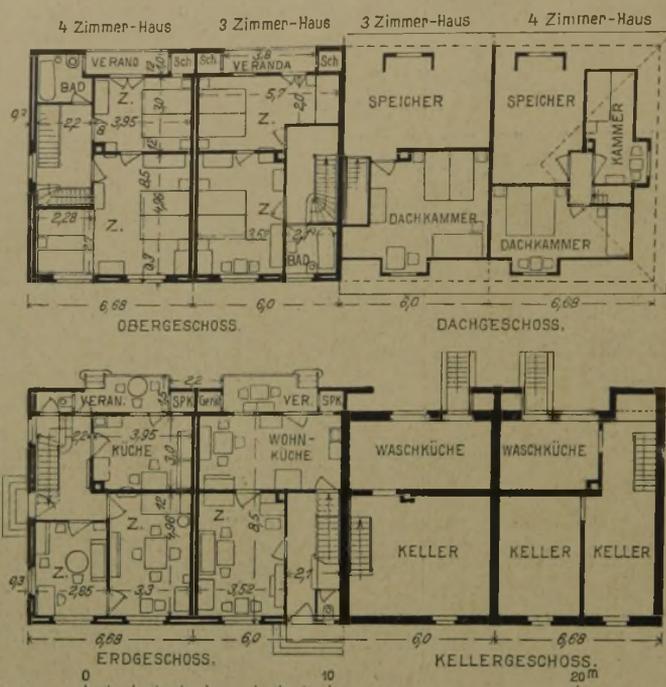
und 4. Grundrisse eines Doppelhauses mit 3 bzw. 4 Zimmern.
